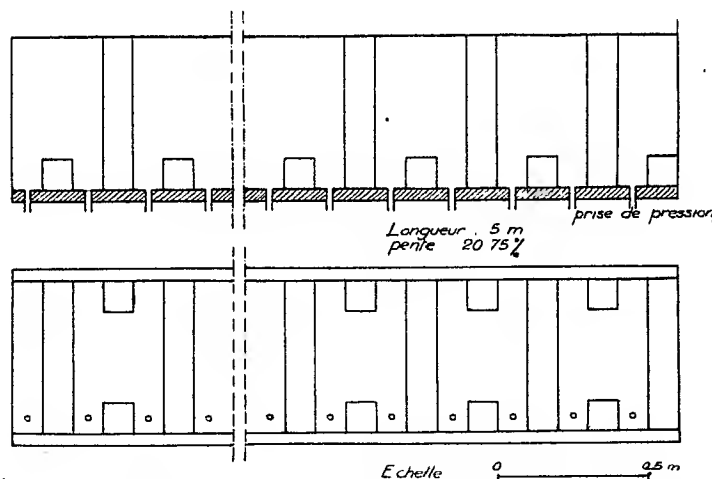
Disposition de l'échelle à poissons rabattue sur un plan horizontal.
